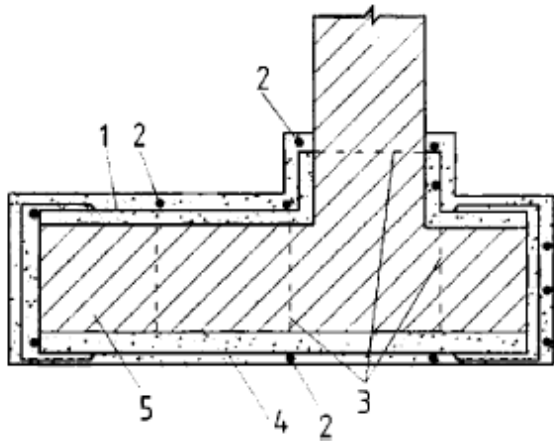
Схема підсилення стіни залізобетонною обоймою ([2]):
